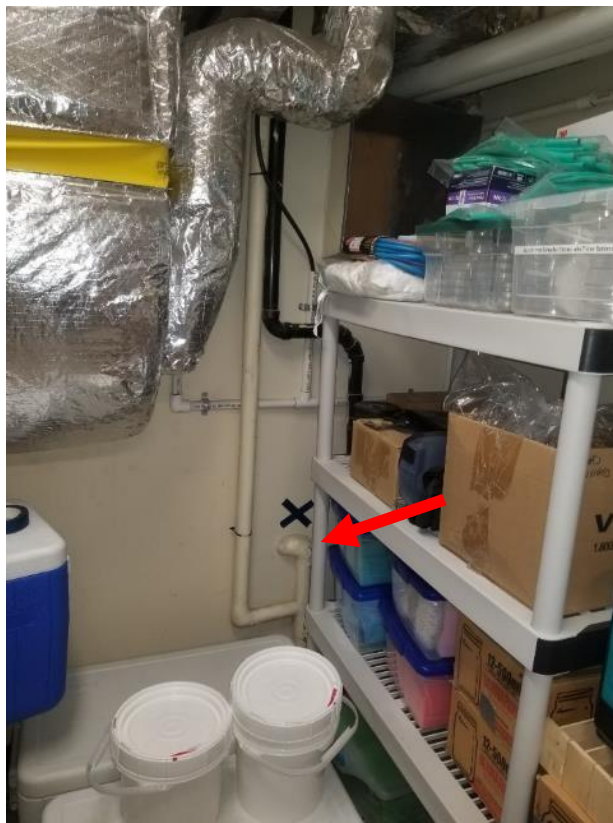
Rez-de-chaussée, local technique, un raccord en mauvais état.
